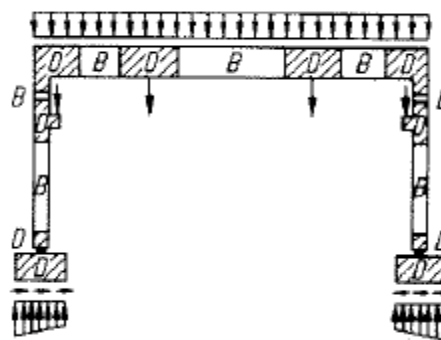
Divisão das zonas B e D num pórtico (Schlaich et al. [8])
